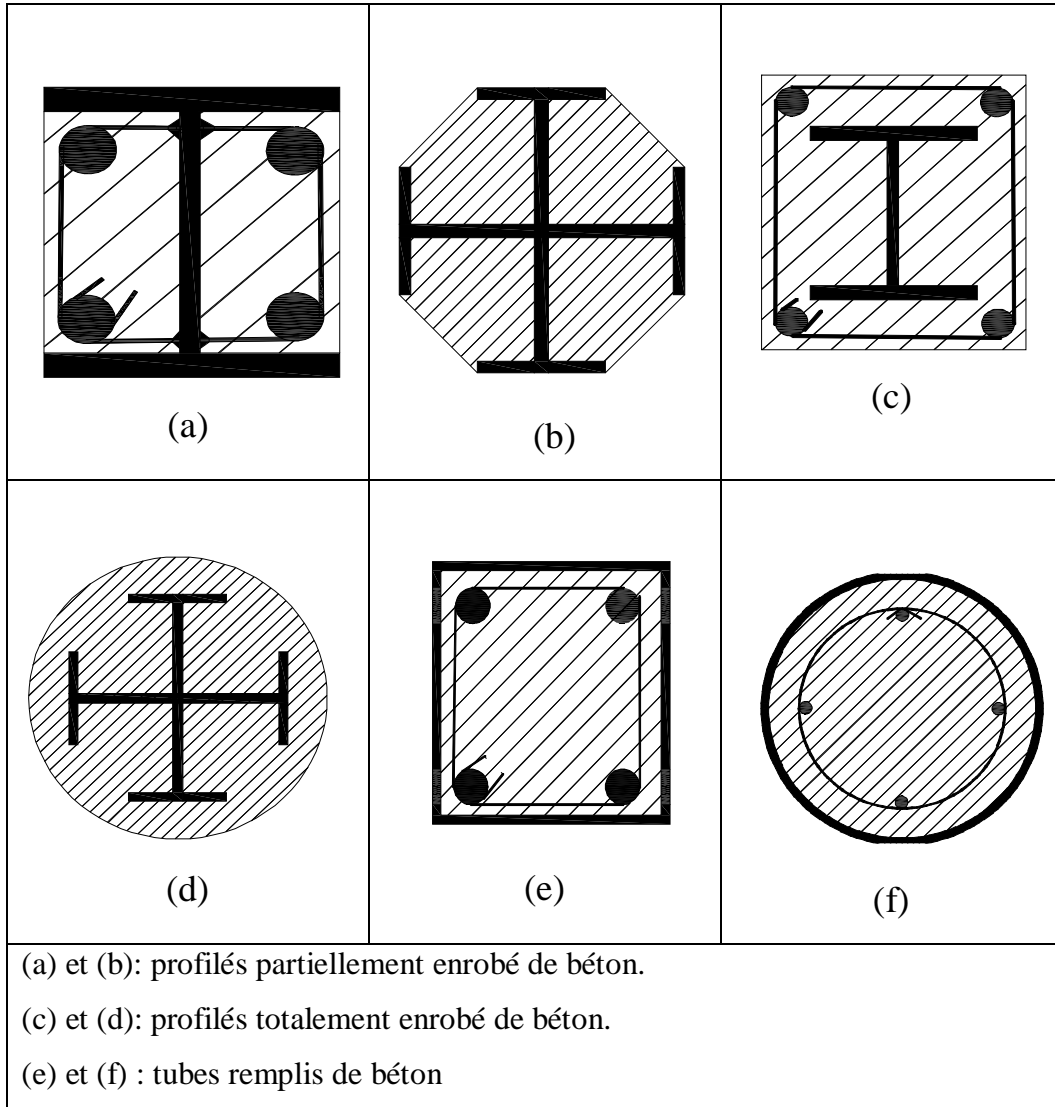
Exemples de sections transversales de poteaux mixtes [12]
